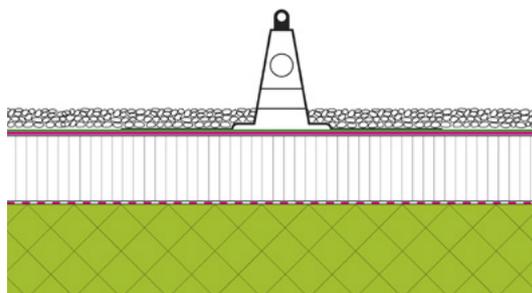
Classe d'équipement 1: PAI monté sur un toit plat avec isolation thermique, variante sur l'étanchéité lestée d'un substrat. (respecter les indications du fabricant, clarifier l'adéquation aux conditions hivernales)
